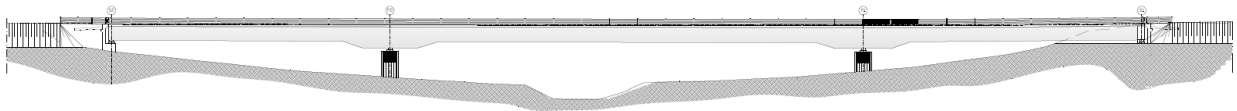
Prospetto Viadotto sul fiume Ornatte
